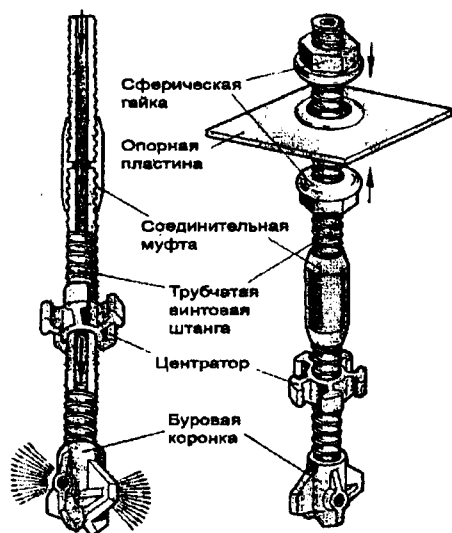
Общий вид трубчатой винтовой штанги «Титан»
